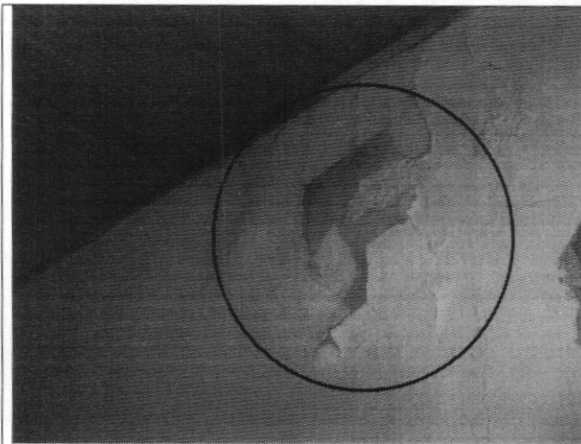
Fisuras y desprendimientos de acabados, muros segundo piso
